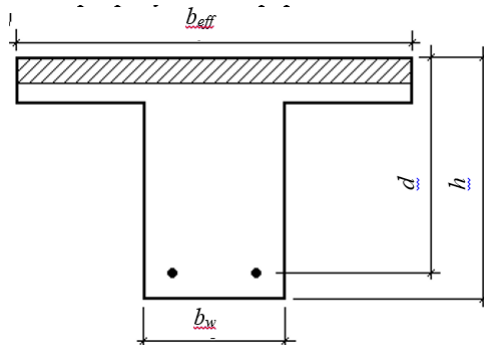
Розрахунковий переріз другорядної балки у прольотах
